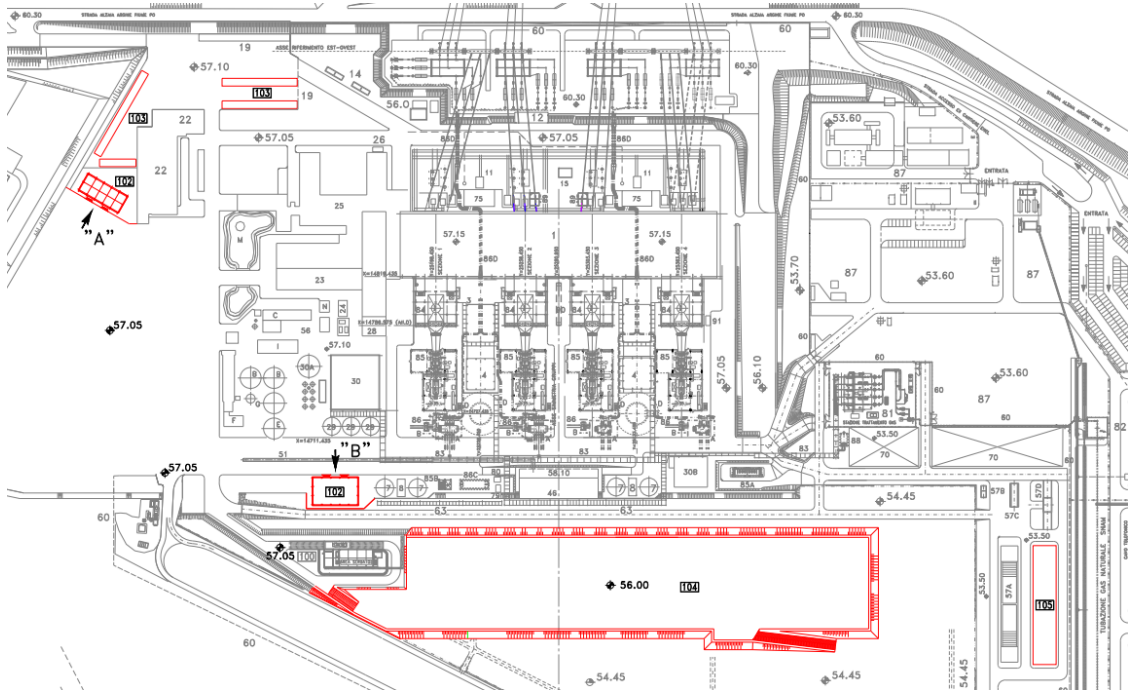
Stralcio planimetria fase "early works" sistemazione area ex serbatoi olio combustibile
